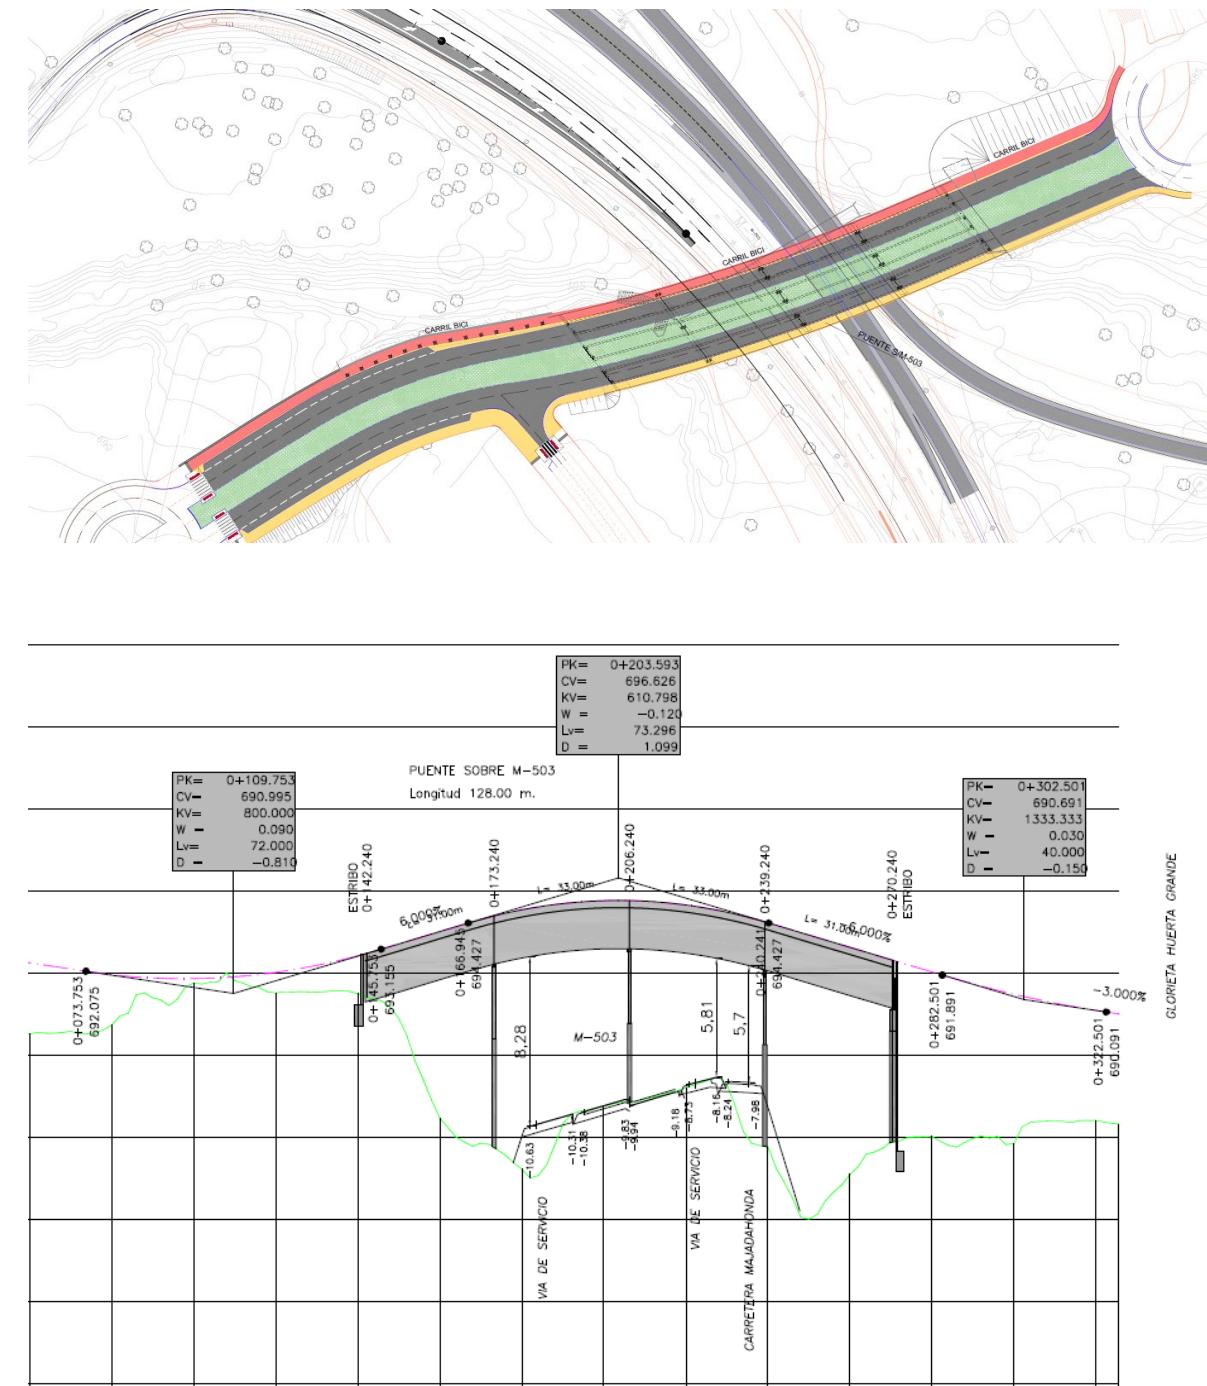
Perfil longitudinal ESTRUCTURA 3
